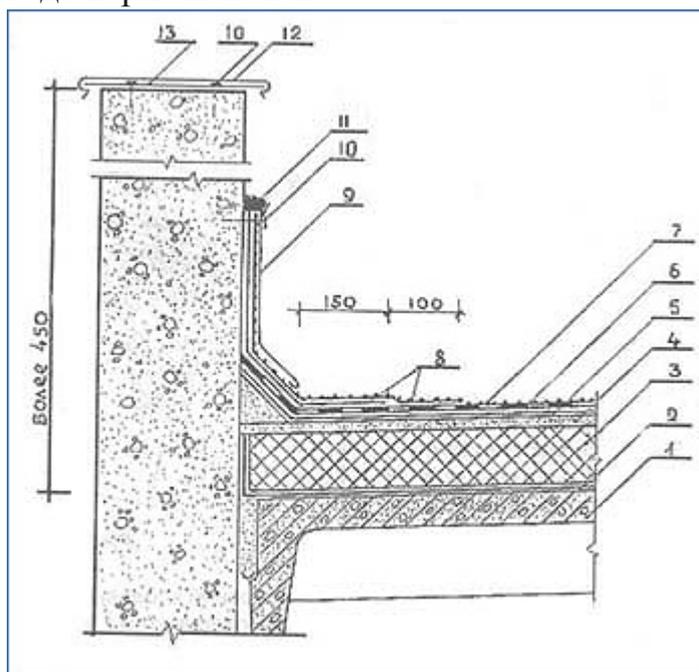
Примыкание кровли к парапету высотой более 450мм: 1 - сборная железобетонная плита покрытия; 2 – пароизоляция; 3 – теплоизоляция; 4 – стяжка; 5 - грунтовка (праймер); 6 - основной кровельный ковёр; 7 - крупнозернистая посыпка верхнего слоя наплавляемого рулонного материала; 8 - дополнительные слои кровельного ковра; 9 - фартук из оцинкованной кровельной стали; 10- крепёжные элементы; 11- герметизирующая мастика; 12 - покрытие парапета (оцинкованная сталь, плиты); 13- костыли стальные 40х4 м через 600 мм
